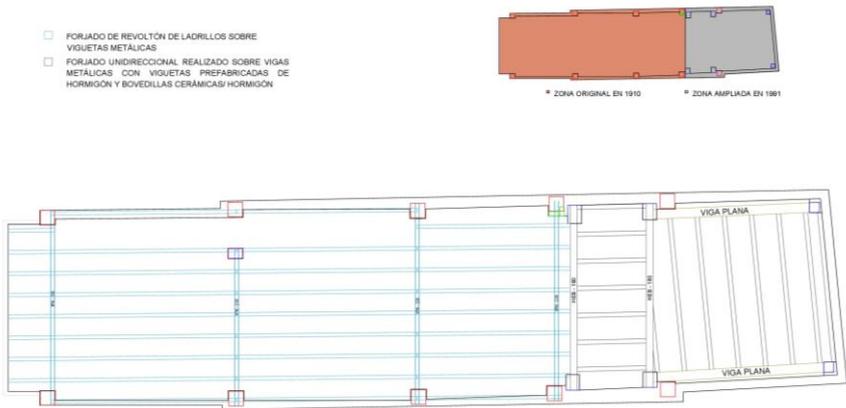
Plano de ampliación de forjado planta baja. 2018 Fuente: Propia
